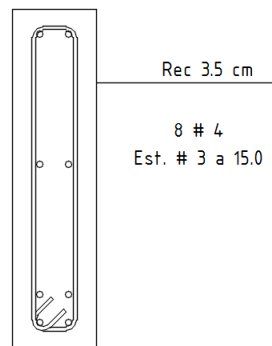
Plano de taller para viga V - 1, Sección Transversal
